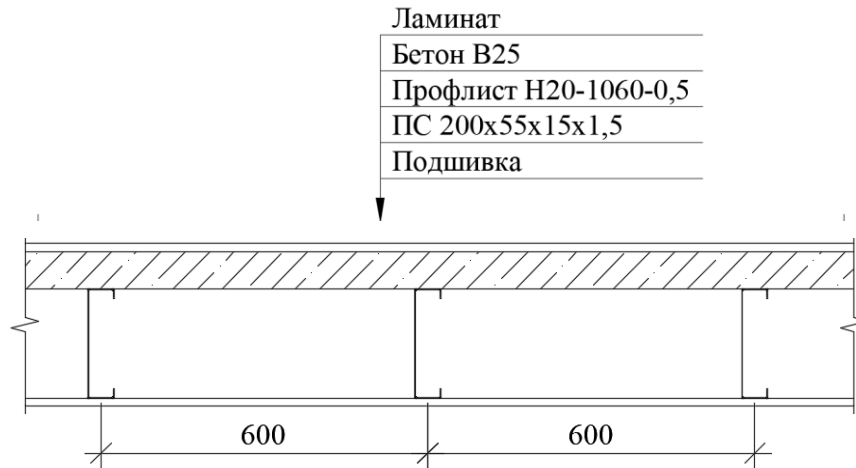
Сечения по конструкции перекрытия.
